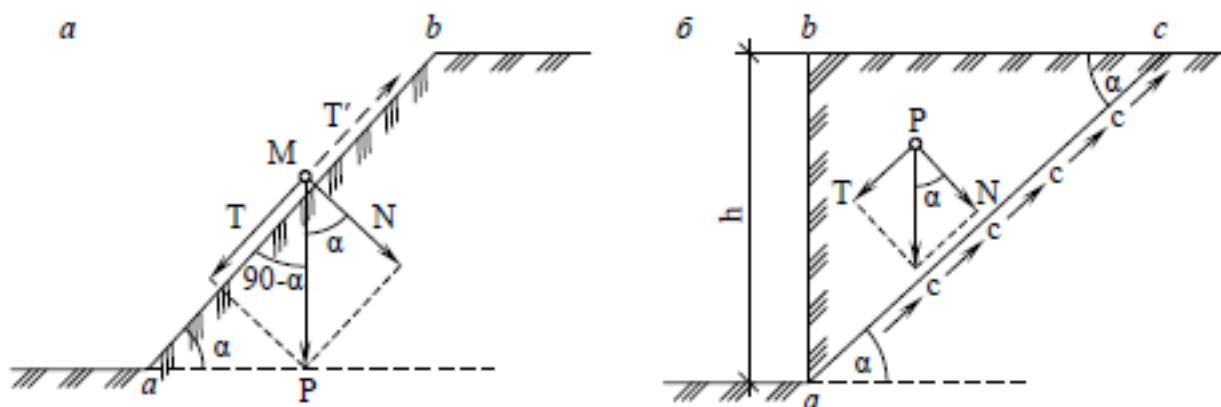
Схема сил, що діють на укіс ґрунту:
